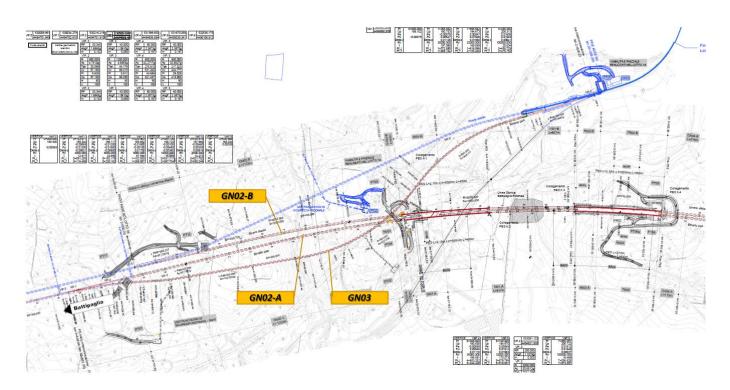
Planimetria di progetto da km 3+750 a km 6+188 BP
